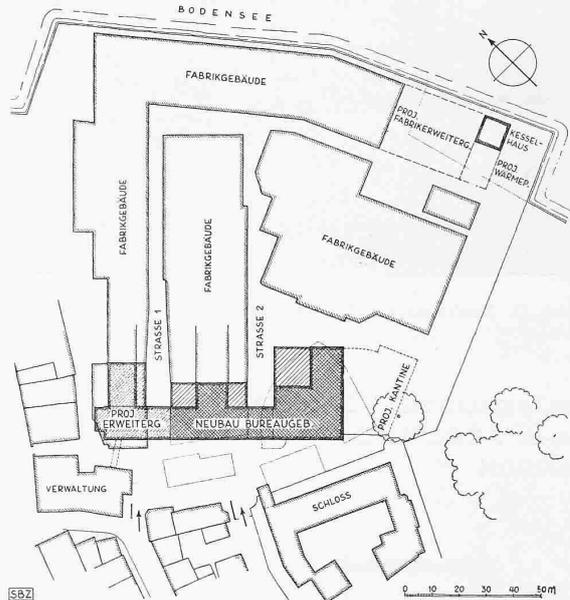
Lageplan des neuen Bureaugebäudes. — 1 : 2500
